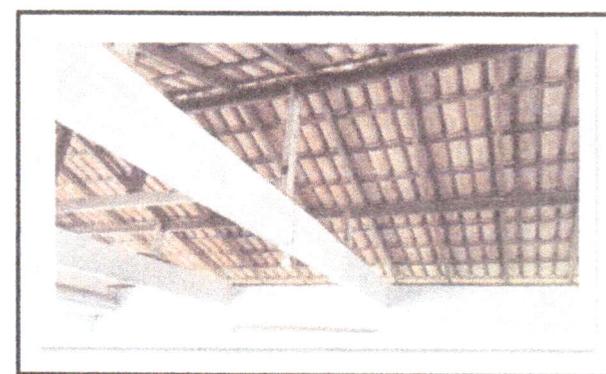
Vista interna da cobertura com vigas em concreto e sem forro.
